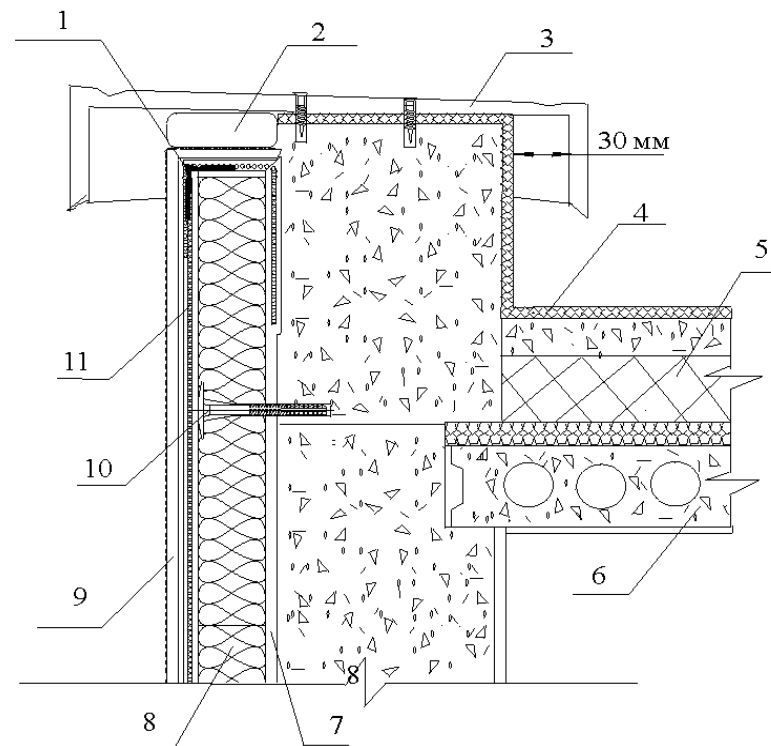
Фрагмент примыкания теплоизоляционного слоя к парапету в верхней части фасада.
